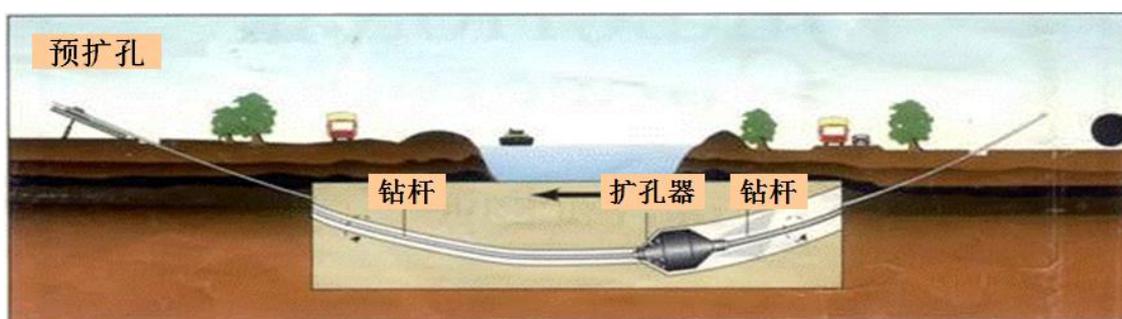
定向钻穿越施工预扩孔过程断面示意图
